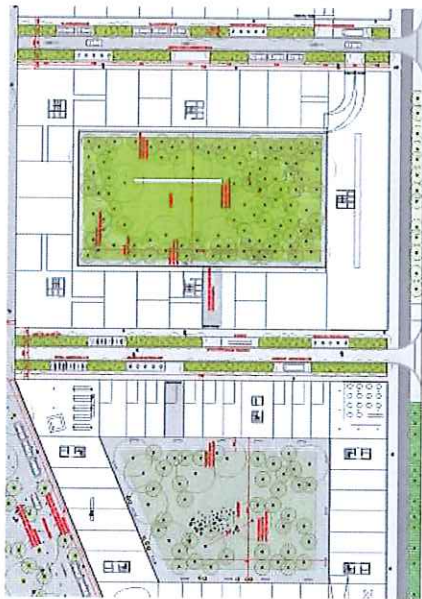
Principes d'aménagements des îlots. Plan guide de la bande centrale, juillet 2015.
